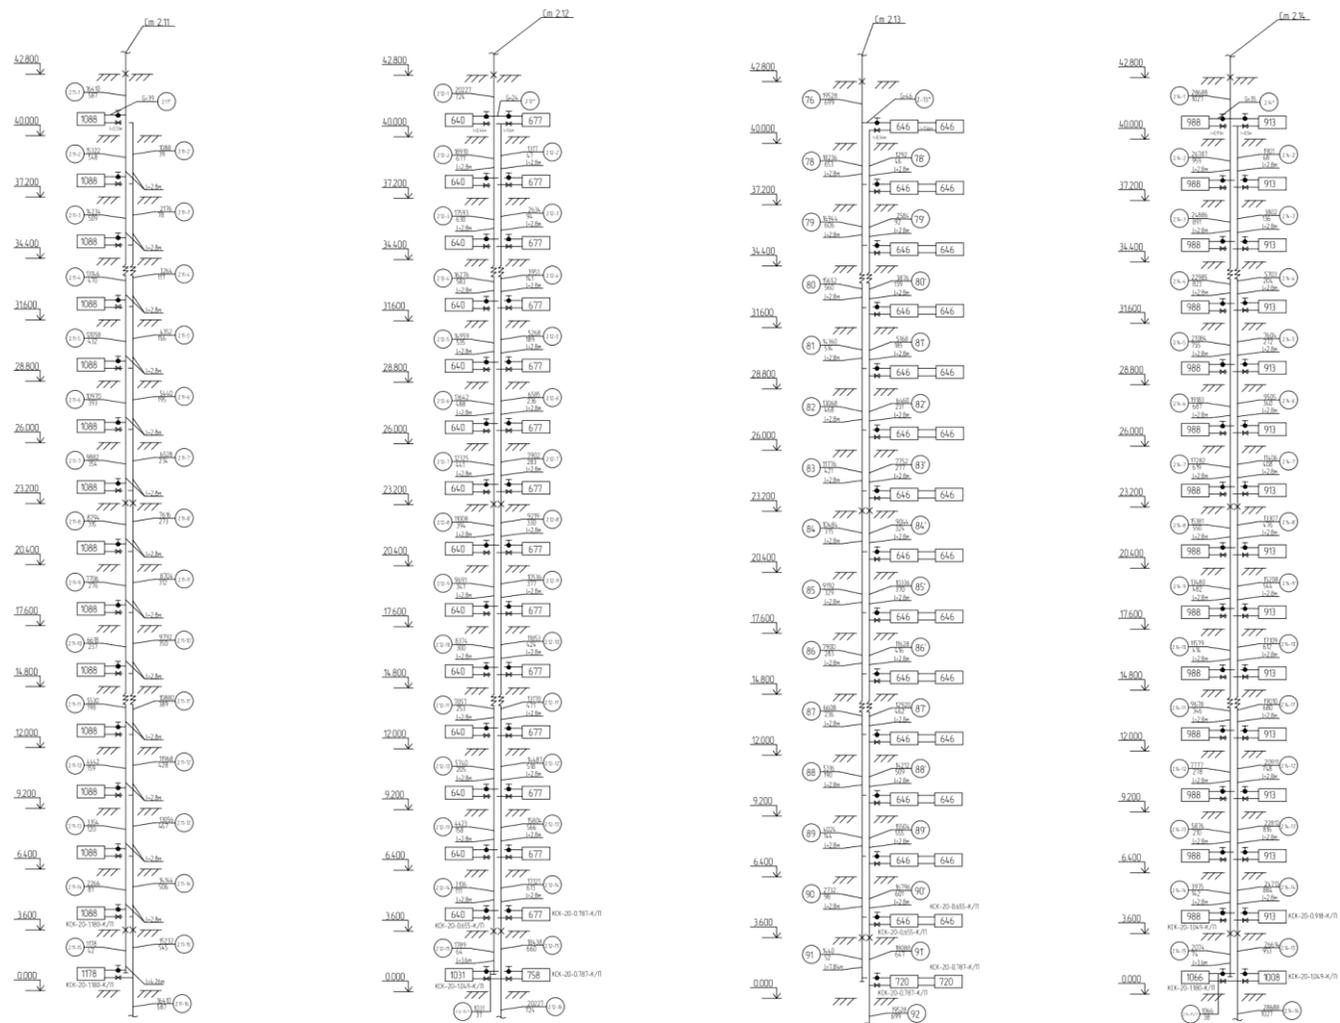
Расчетная схемы стояков 2.11-2.14
